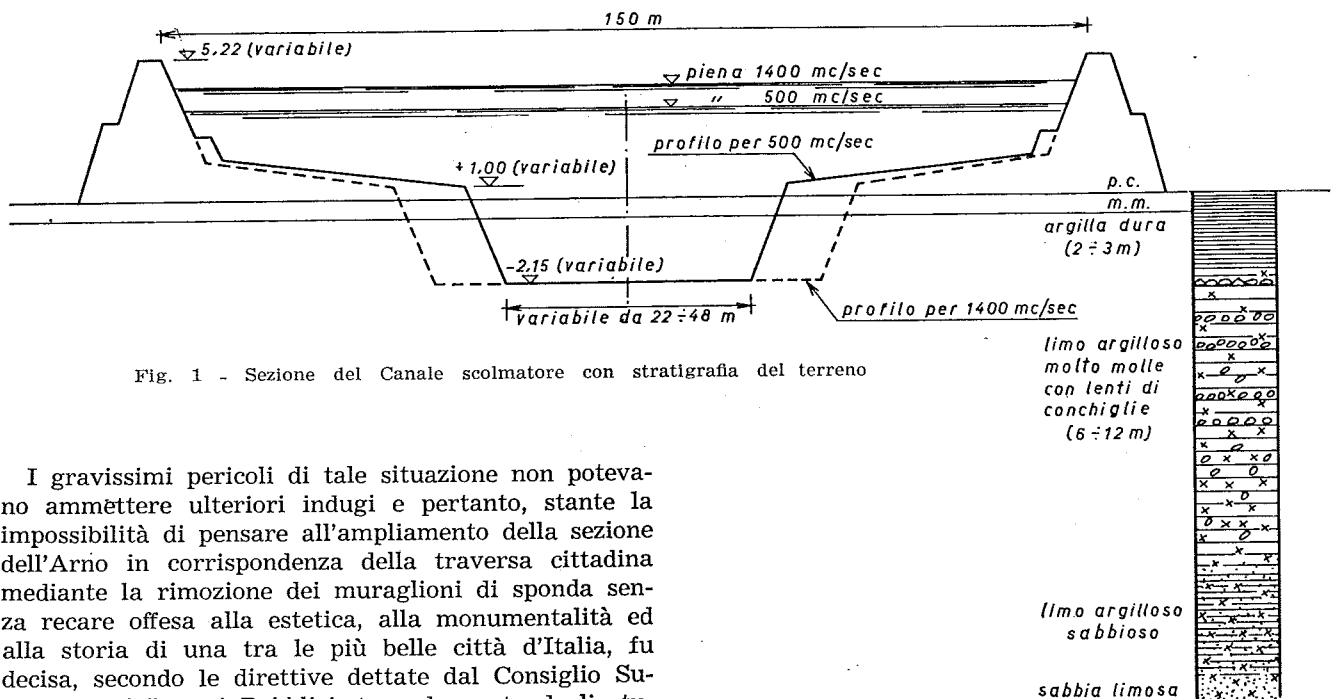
Sezione del Canale scolmatore con stratigrafia del terreno
